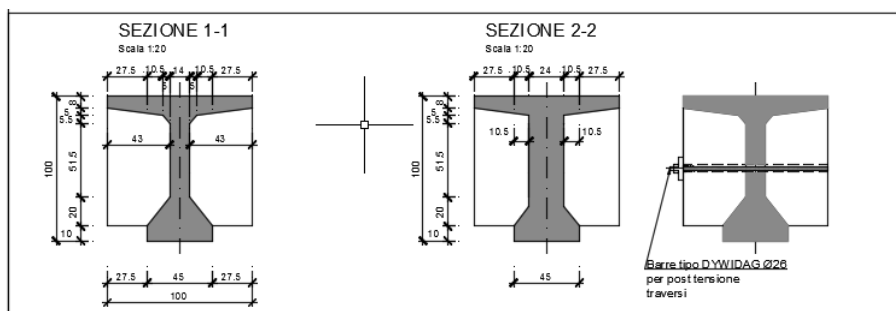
Sezione trasversale impalcato (sezione in campata)
